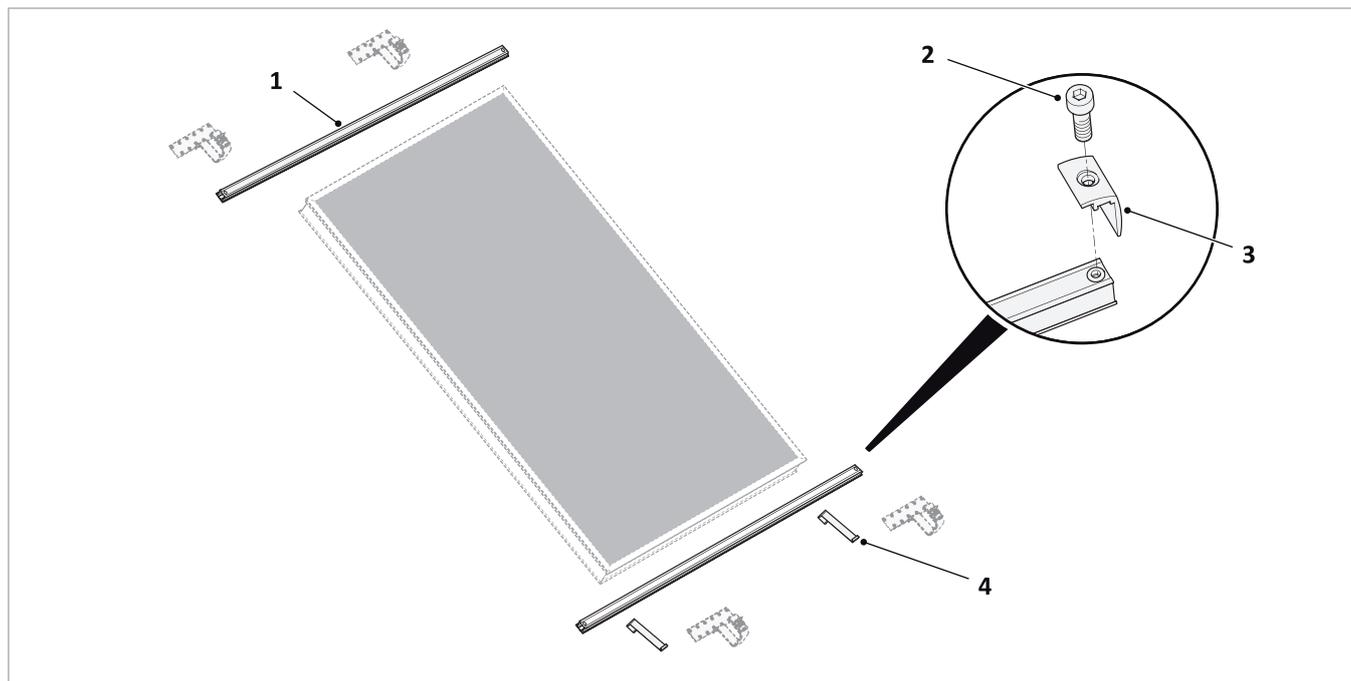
kit guide sul tetto (collettore e supporto per fissaggio sul tetto non compresi nella fornitura).
